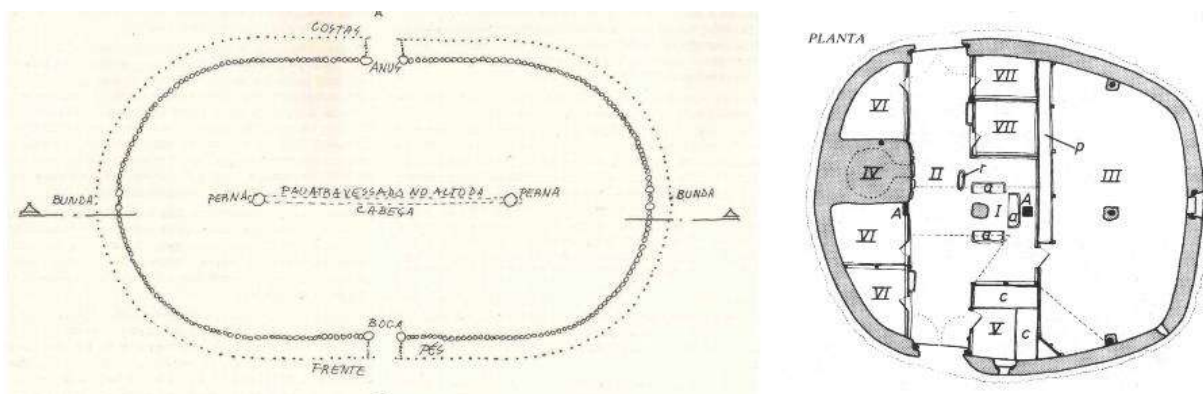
Planta-baixa de uma Oca indígena e planta baixa de uma palloza.
